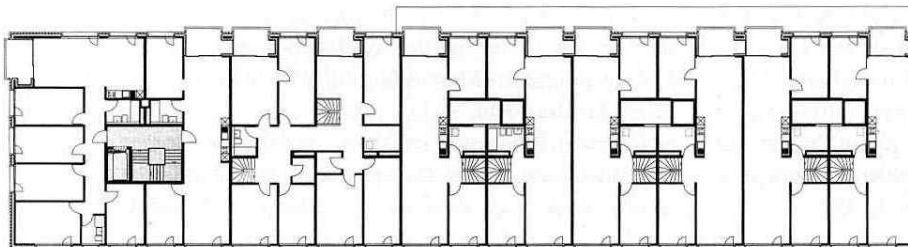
Grundrisse Haus A, 4. bis 7. Obergeschoss
